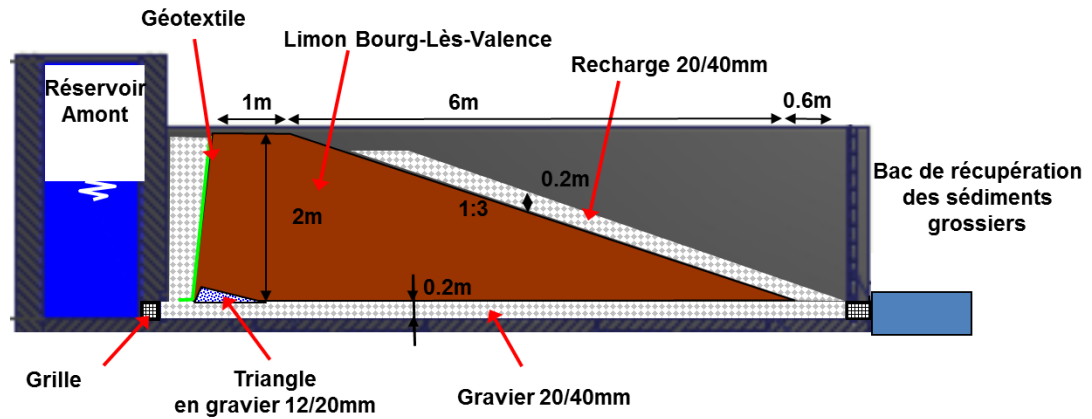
Schéma de l'ouvrage des essais 5, 6 et 7.
